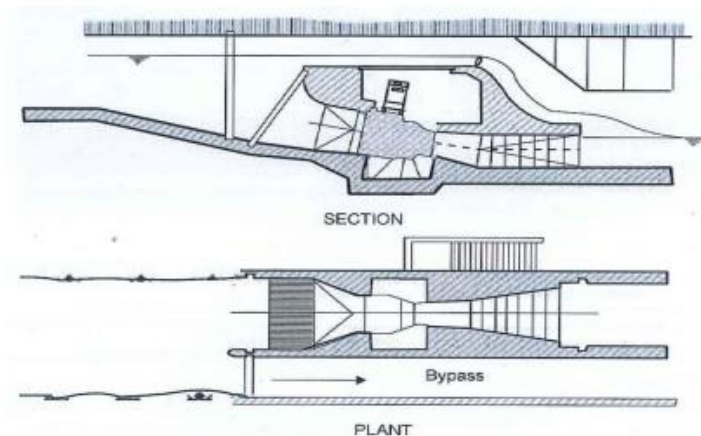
Sección y planta de un ensanchamiento del canal. Fuente [11]
